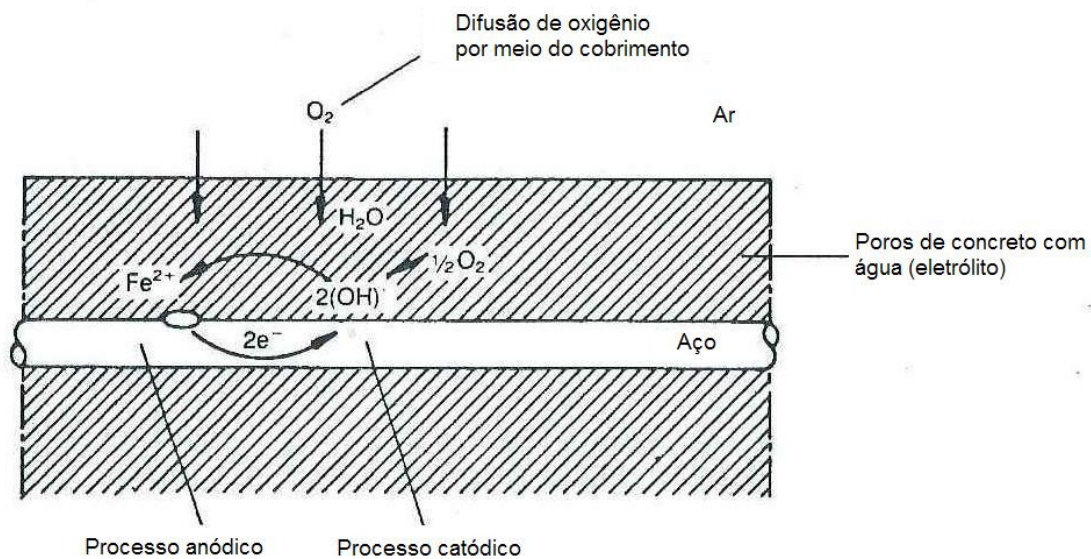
Modelo simplificado para corrosão das armaduras de concreto, CEB-183 (1992)
